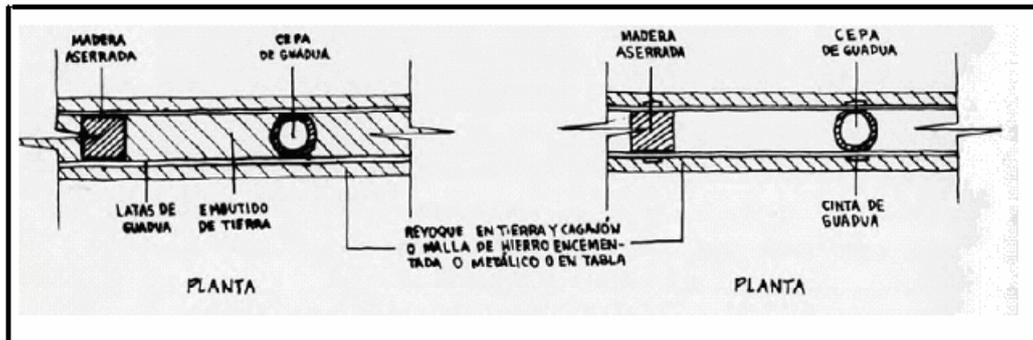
Vista en planta Bahareque hueco y Bahareque macizo
